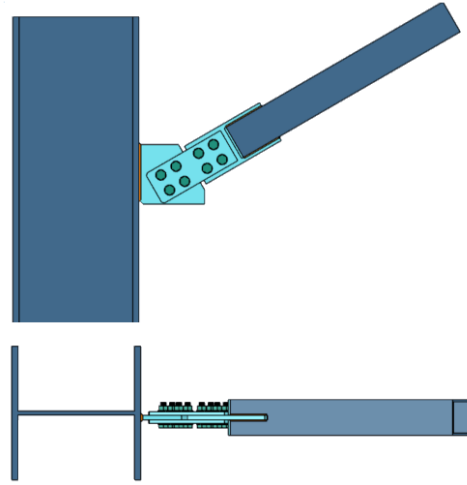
Articulation poteau-barre de contreventement en tube carré avec éclissage sur gousset
